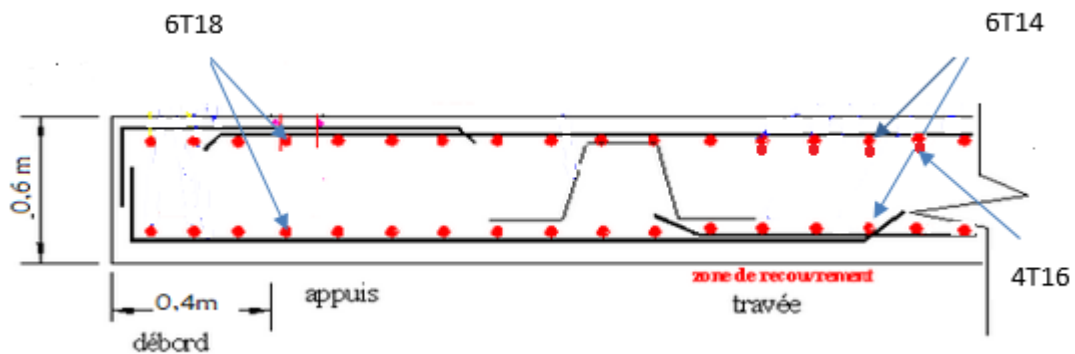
Plan de ferrailage du radier général suivant y-y.
